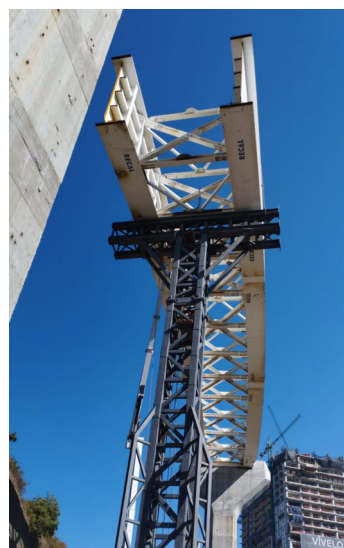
Montaje viga metálica en vano 4 con apeo provisional (Fase 1).
